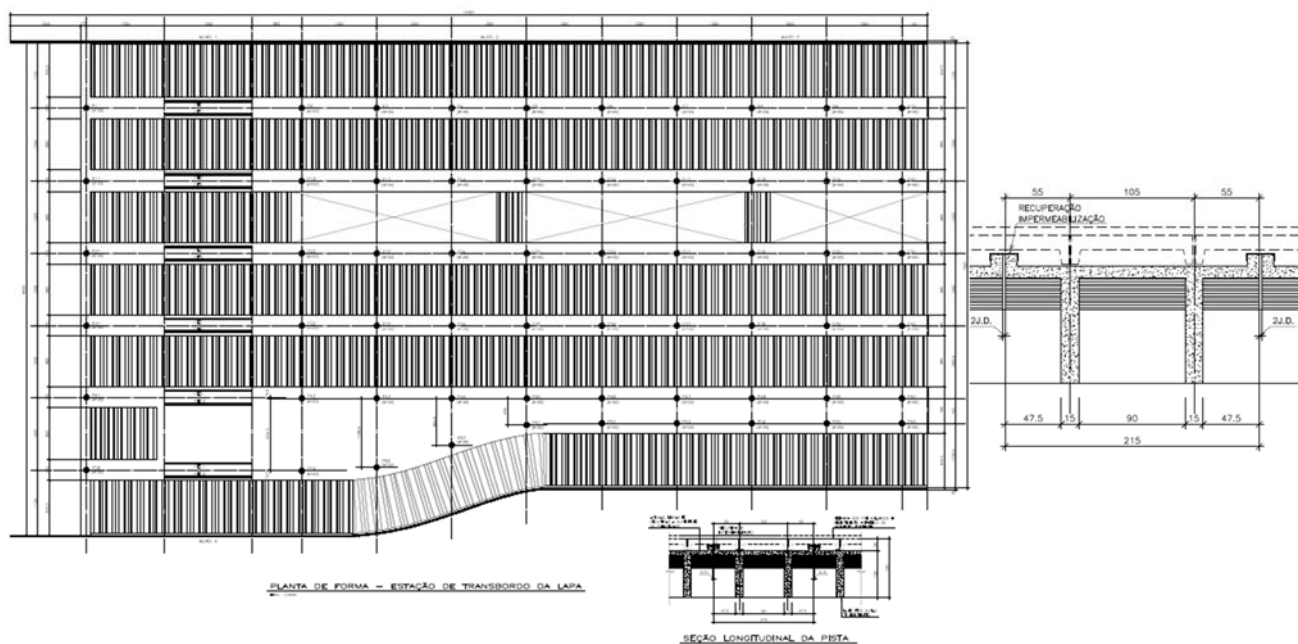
Planta e Seção Típica da Estação de Transbordo da Lapa
